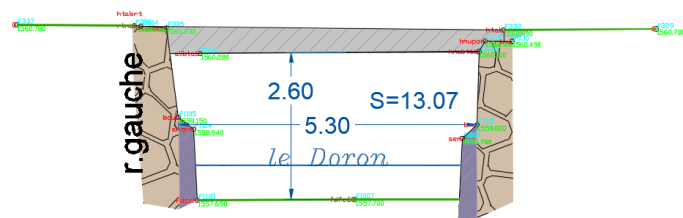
Ouvrage traversant n°3 – profil topographique (face amont)
